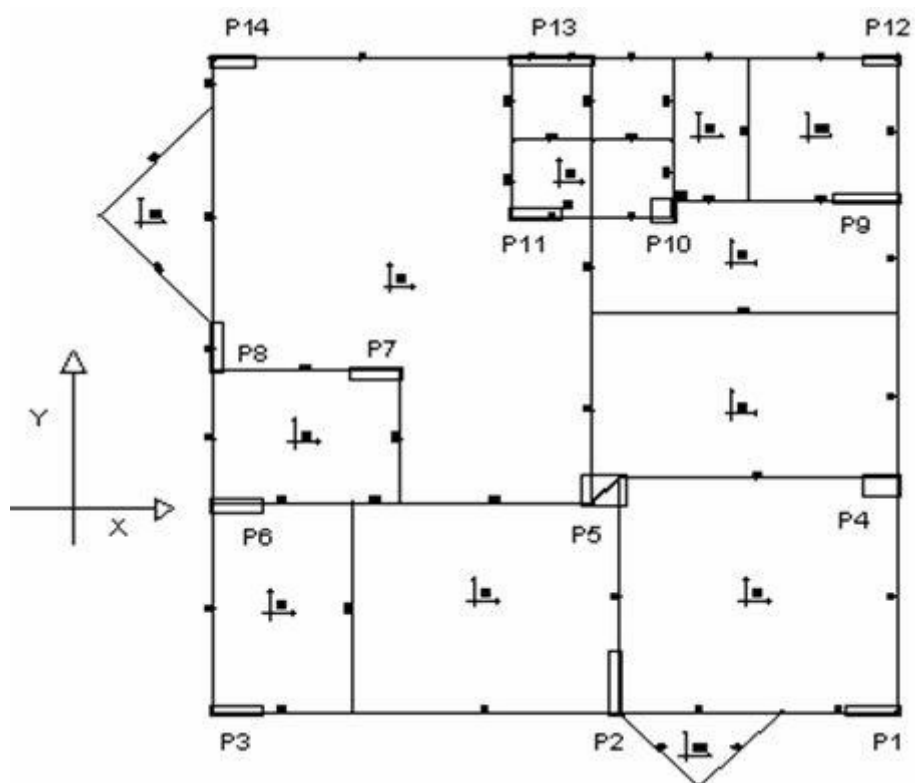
Esquema da distribuição de pilares, vigas e lajes do pavimento tipo – edifício “A”.
